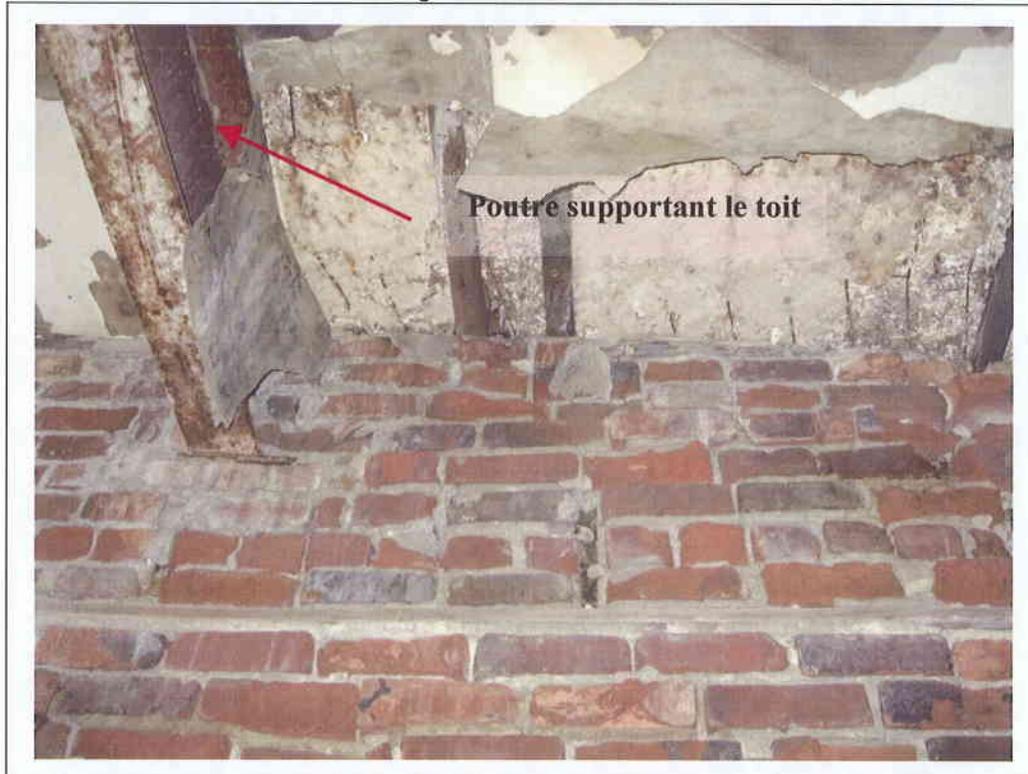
Zoom sur la section de mur notée D en photo No. 19 : section de briques très instable.
